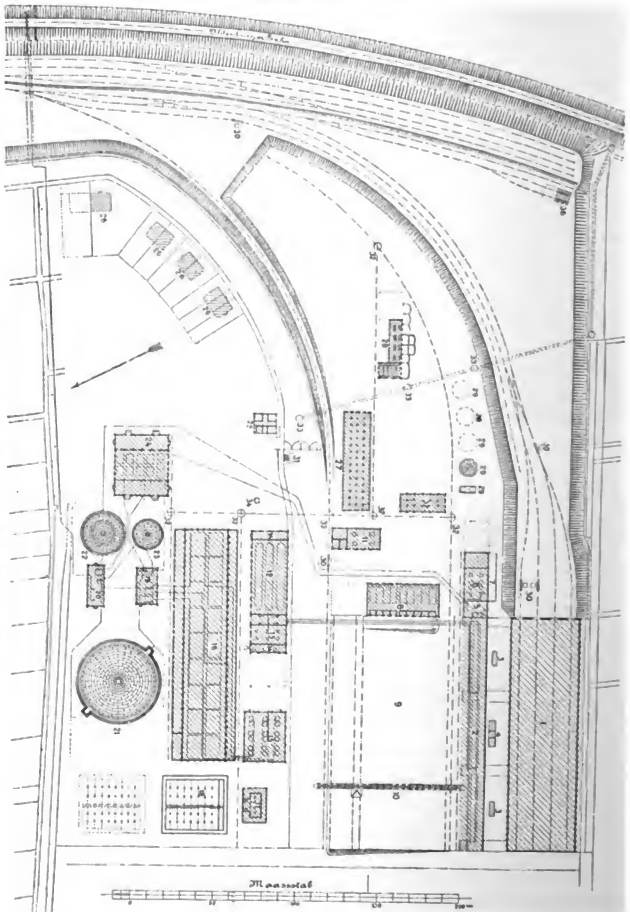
Lagerplan des Gaswerks Bremen-Volmershausen.
